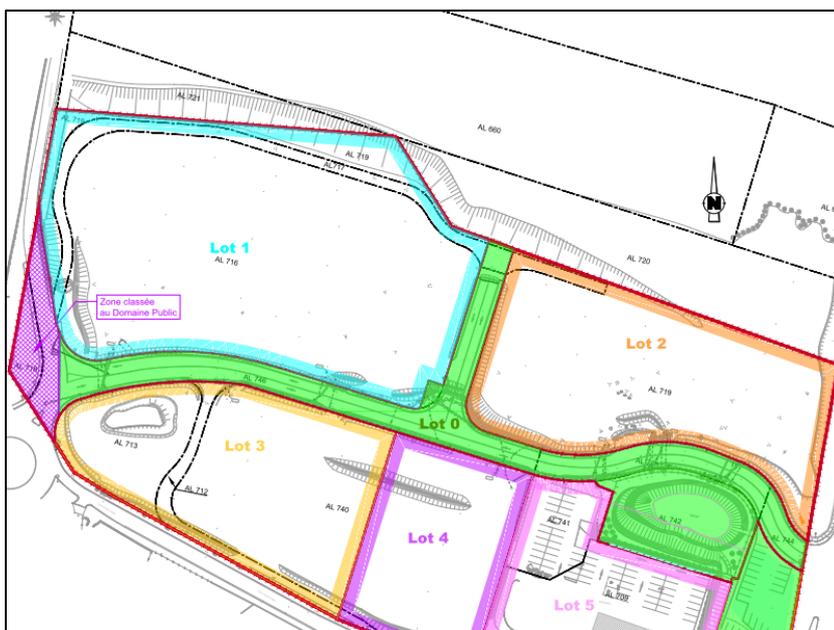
Plan d'aménagement du projet de lotissement Terres Neuves
